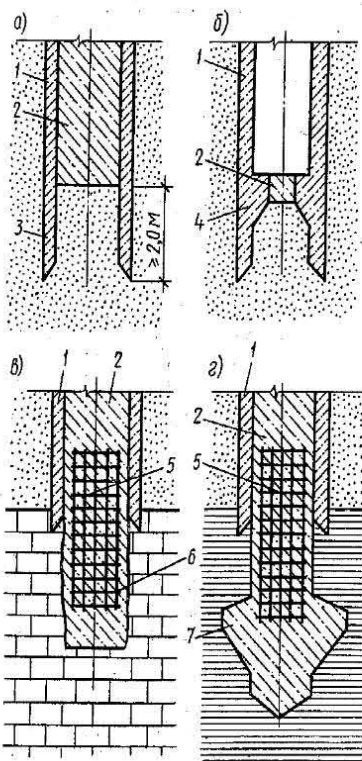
Конструкция сборных железобетонных оболочек:
